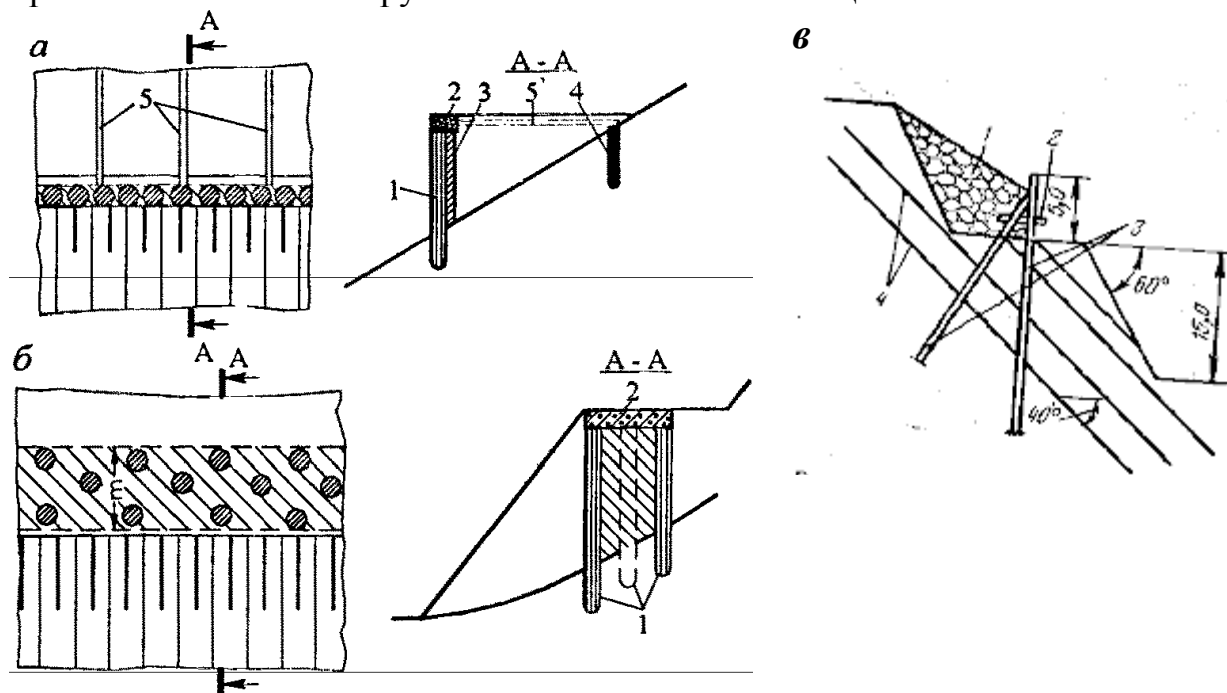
Схемы установки свай: *а* – в один ряд; *б* – в несколько рядов: 1 – свая; 2 – железобетонный ростверк; 3 – затяжка; 4 – анкер; 5 – анкерная тяга; *в* – схема укрепления уступа: 1 – разрыхленная порода; 2 – бревенчатый щит; 3 – сваи; 4 – трещины ослабления
